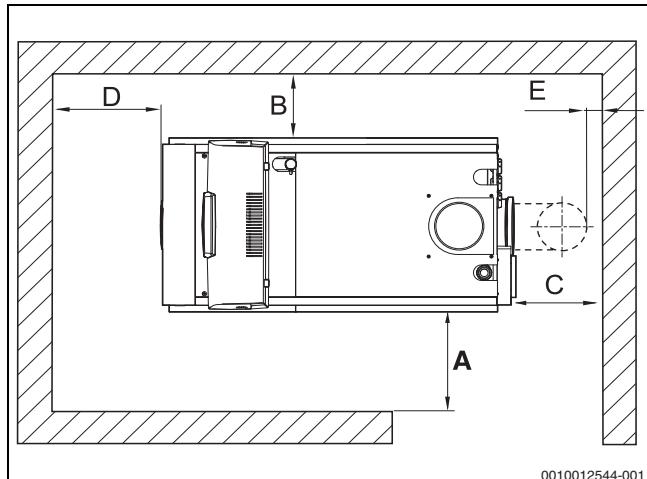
Wandabstände im Aufstellraum (Rechts-Ausführung)
